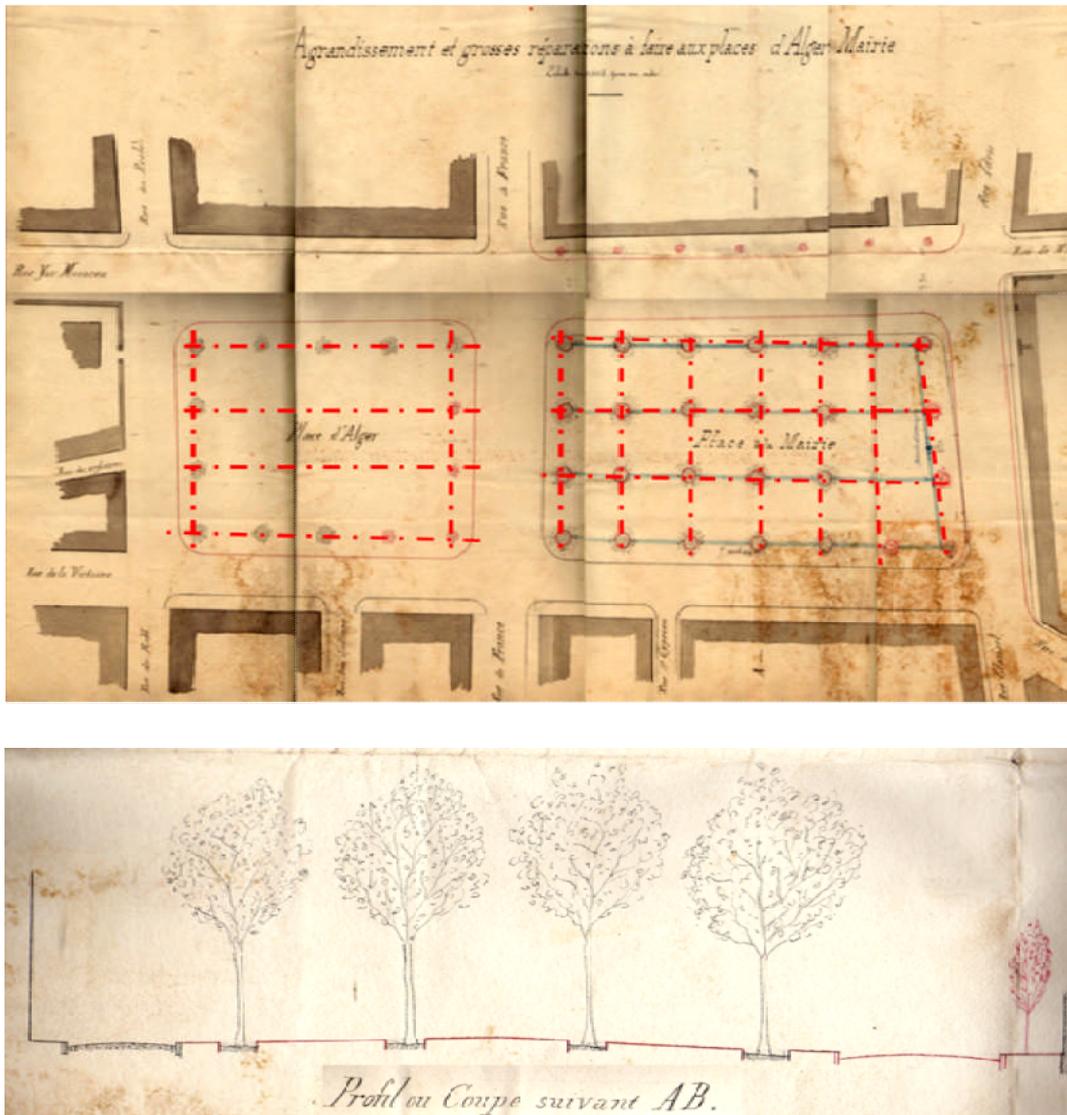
Plan et coupe des places d'Alger et de la Mairie en 1889.
